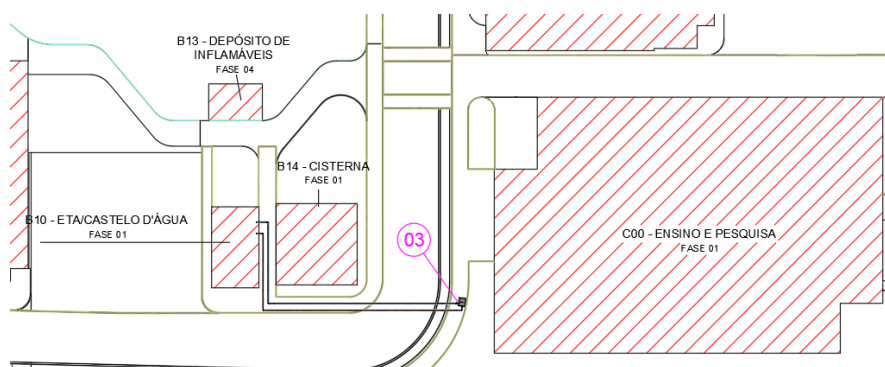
Planta trecho (Castelo d'água / Bloco C00)
